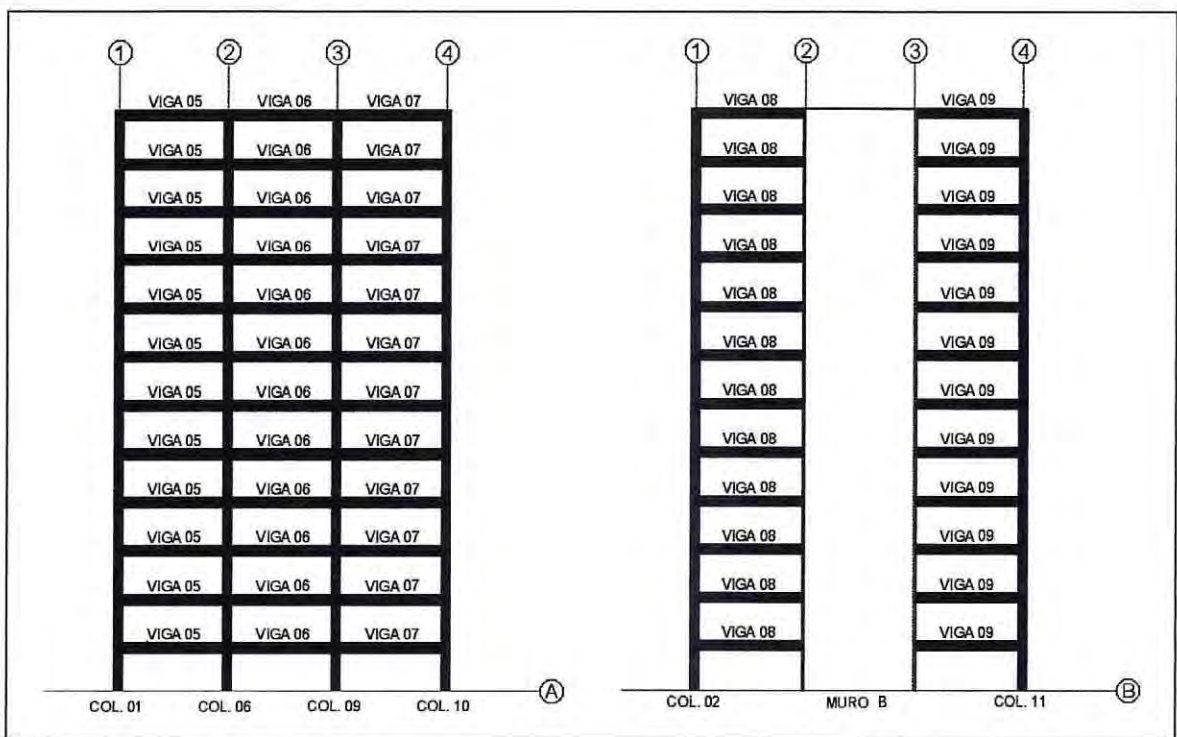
Distribución de las vigas y columnas en los ejes A y B en dirección Y.
